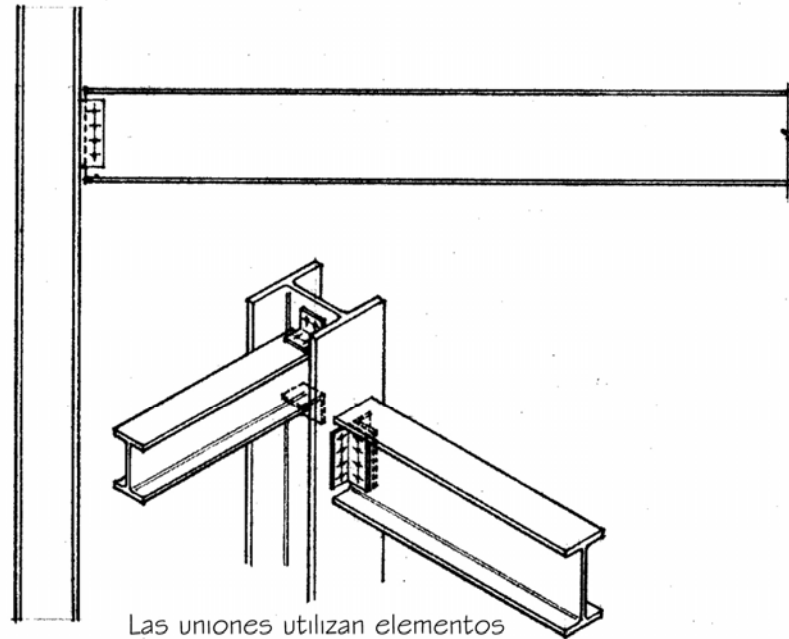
Se muestra el uso de vigas y columnas WF.
